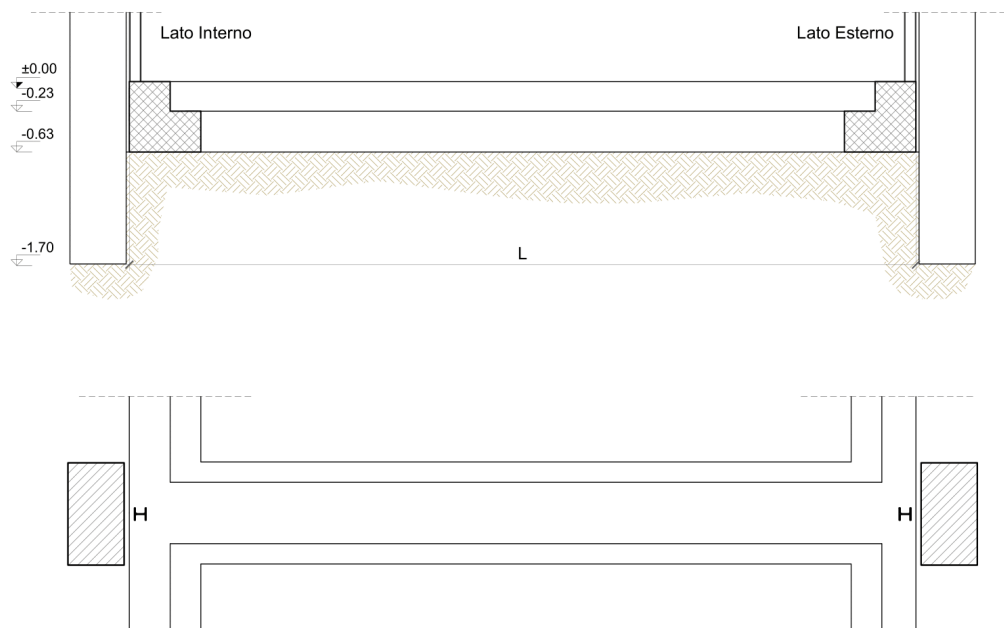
Trave rovescia di fondazione a collegamento delle nuove colonne.
